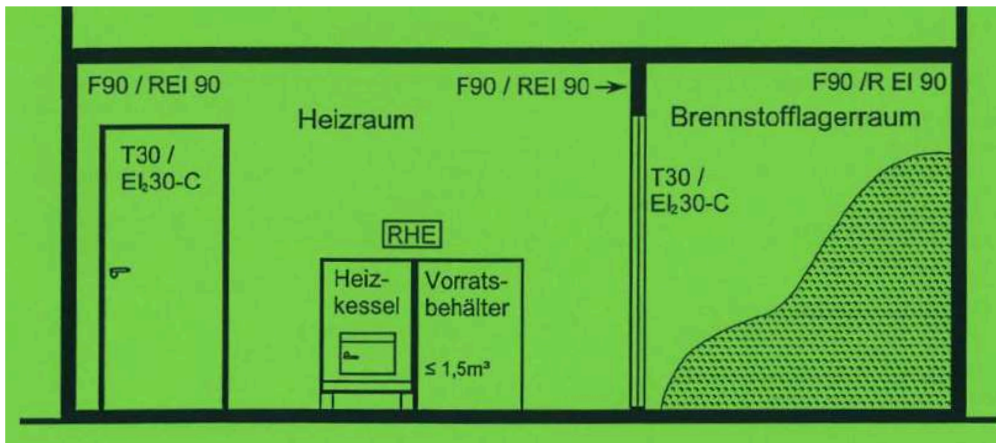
Kompaktanlage im Heizraum (5.1.3) mit anschließendem Brennstofflager (5.1.3), Heizleistung ≤ 150 kW, Brennstoff gemäß Punkt 3.1 (Hackgut)
